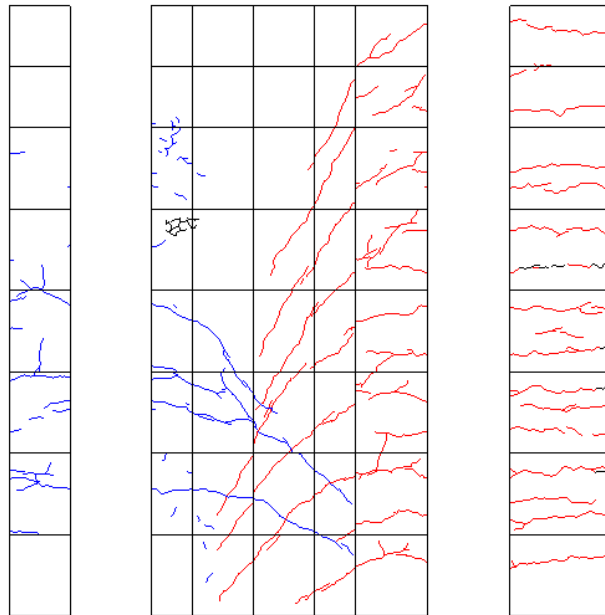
R=-1/100 ひび割れ図
